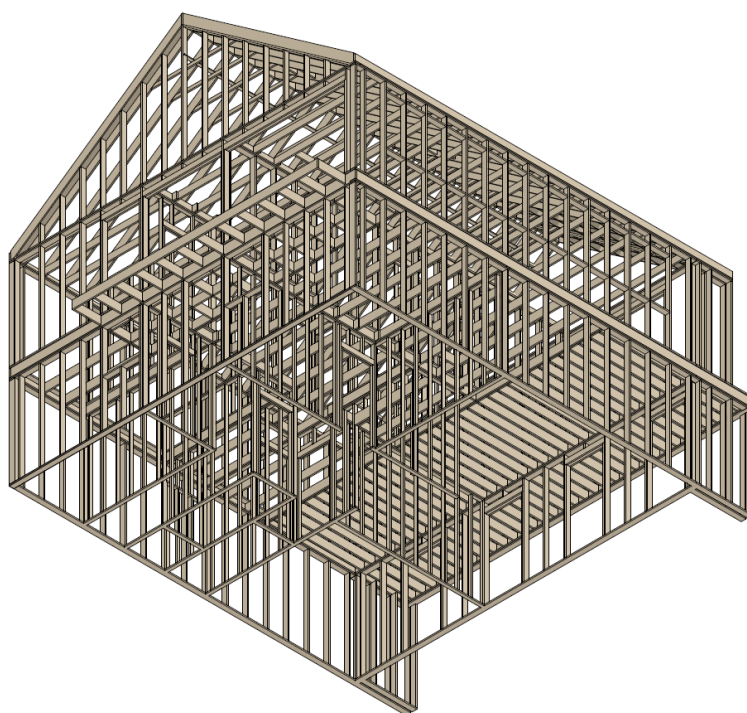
Axonometria noroeste da solução estrutural de reticulados leves.
